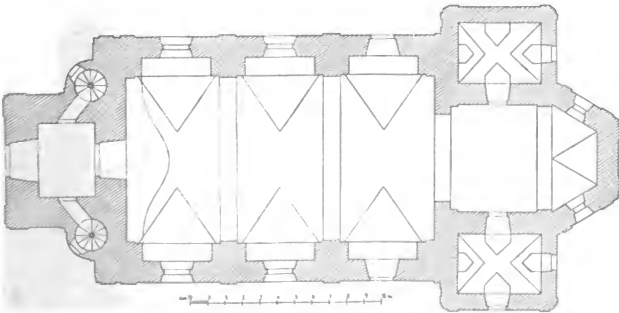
Chodeč. Grundriss der Kirche.
